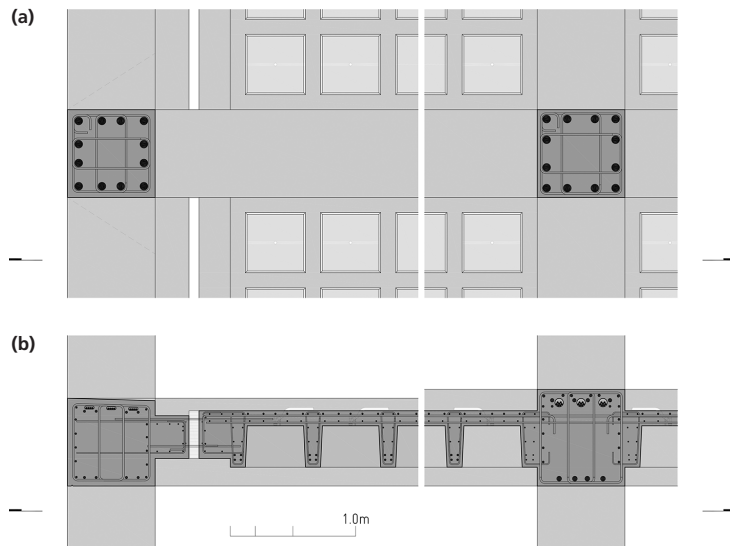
Particolare dei solai a cassettoni e delle nervature: a) pianta e b) sezione. Detail of the coffered slabs and ribs: a) plan view and b) cross-section.
